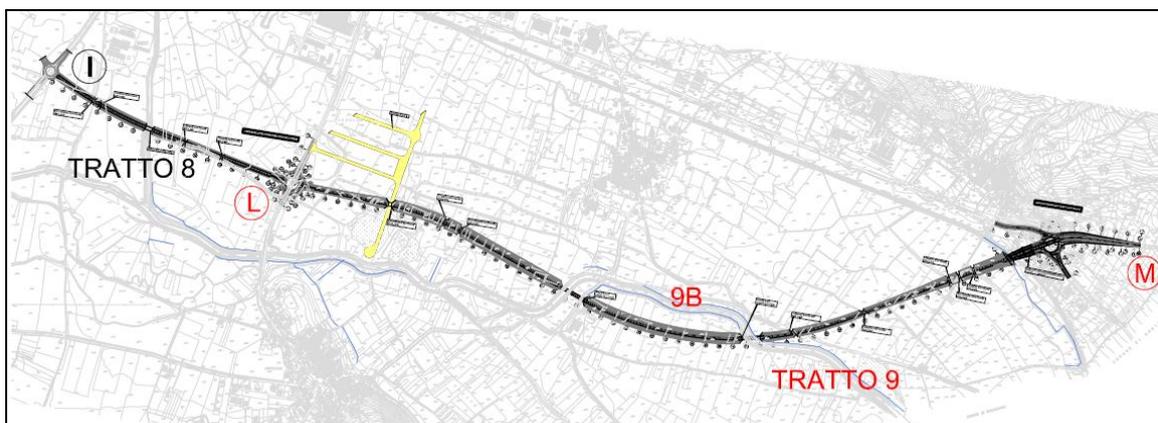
Planimetria LOTTO C con Alternativa di progetto 9B
